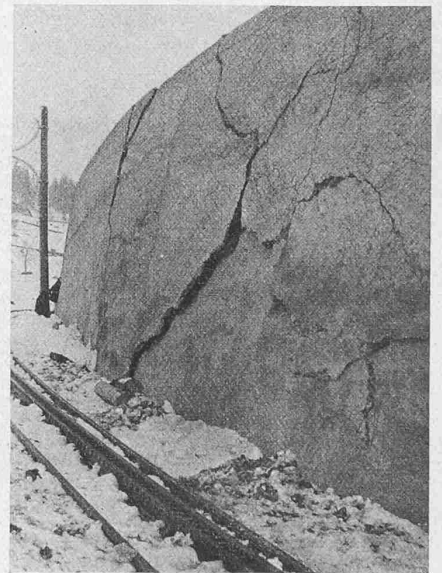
Zerstörte Betonfuttermauer bei Km. 2,47.
